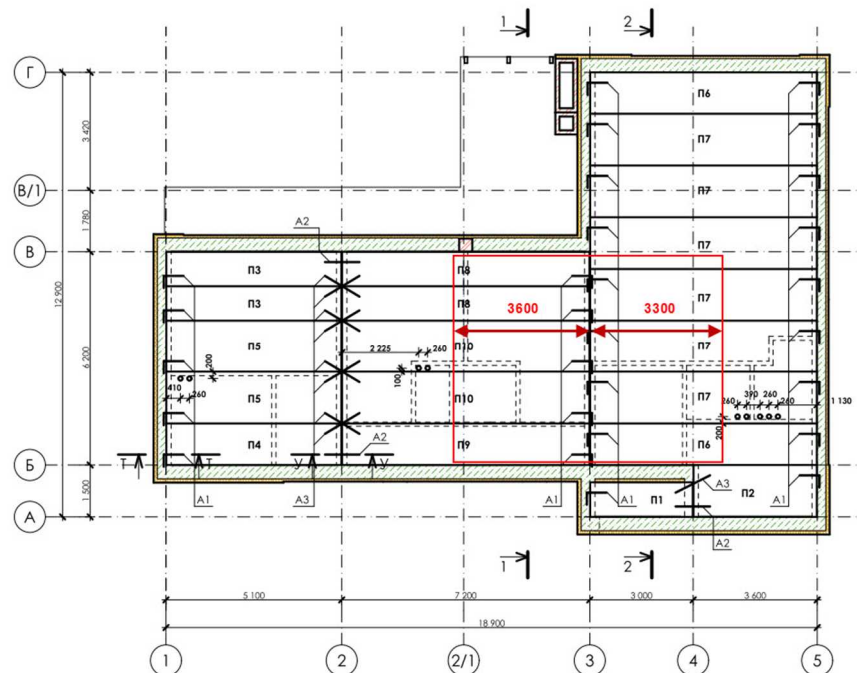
Грузовая площадь нагруженного участка по оси Б3-В3.
